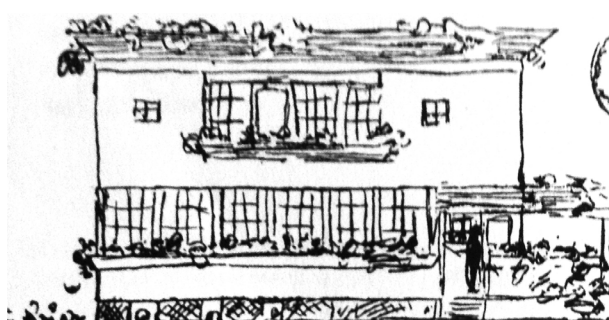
Fachada de outra casa com estrutura tipo Dom-Ino.
